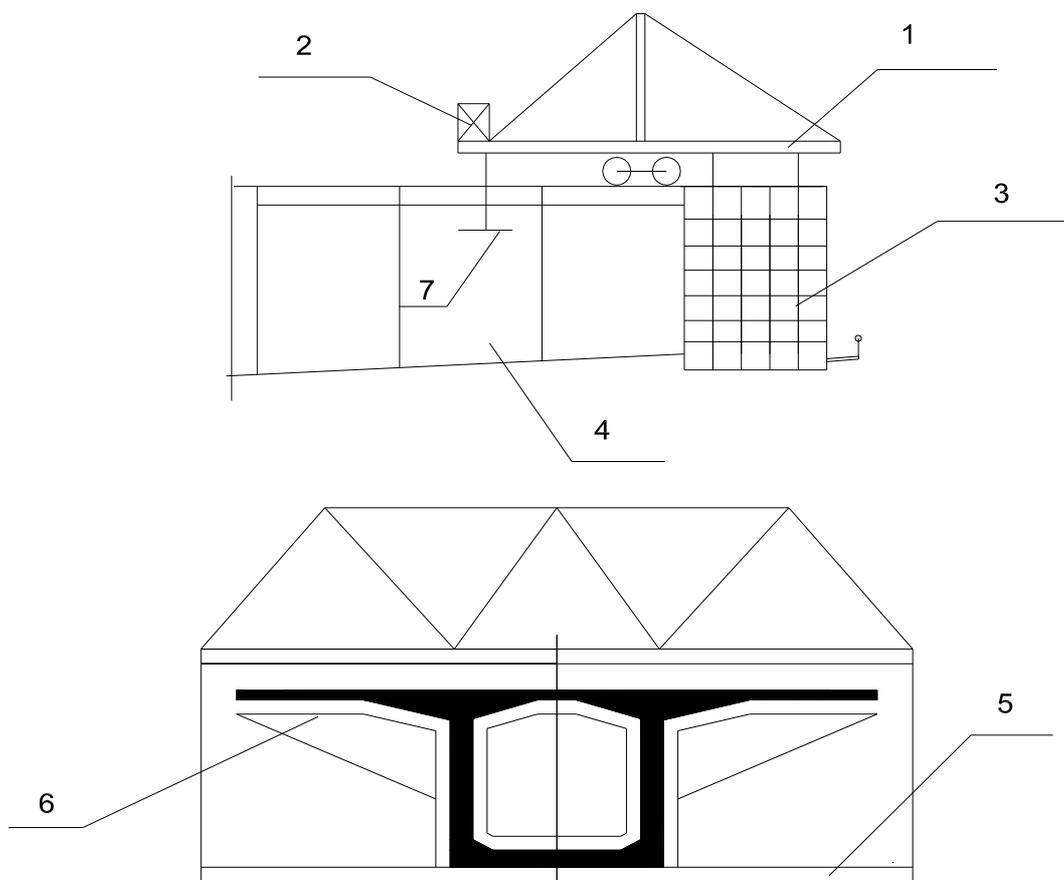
Агрегат для навесного бетонирования: 1-консоль; 2-противовес; 3-опалубка; 4-секция бетонирования длиной 3...4м; 5-нижние подвесные подмости; 6-опалубка; 7-анкер
